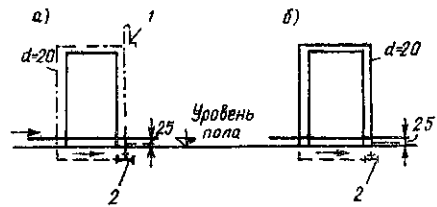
Схема устройства обводных трубопроводов у дверных проемов
